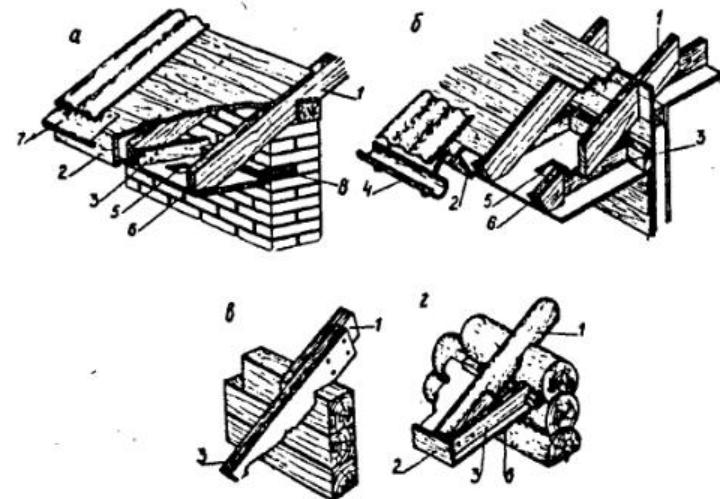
Типы карнизов для стены: а — кирпичной; б — кар-касной; в — брускатой; г — бревенчатой. 1 — стропила; 2 — карнизная доска; 3 — кобылка; 4 — водосточный желоб; 5 — вентиляционная решетка; 6 — подшивка отделочной доской; 7 — отлив из оцинкованной стали; 8 — просмоленная дере-вянная пробка.
